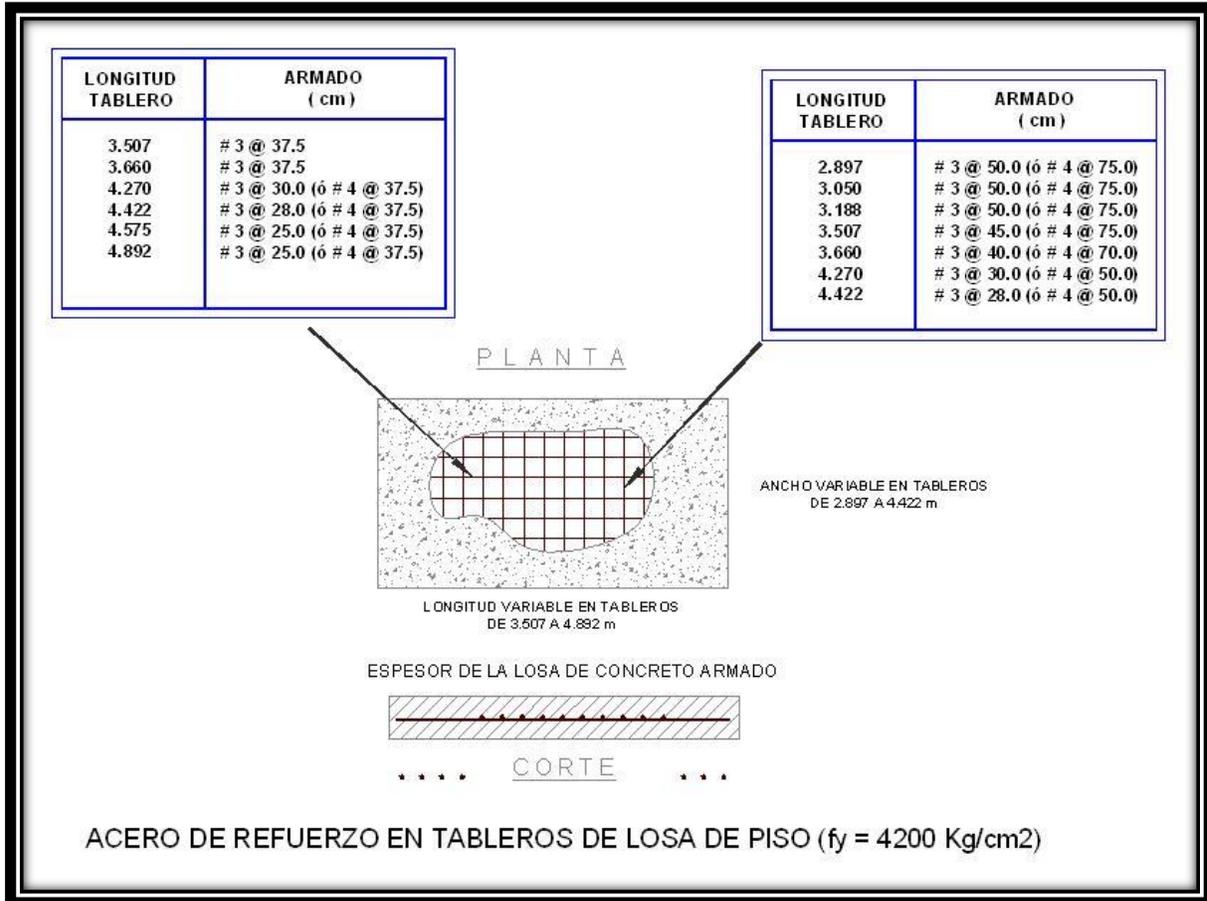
ACERO DE REFUERZO PARA LOSAS DE CONCRETO HIDRÁULICO
